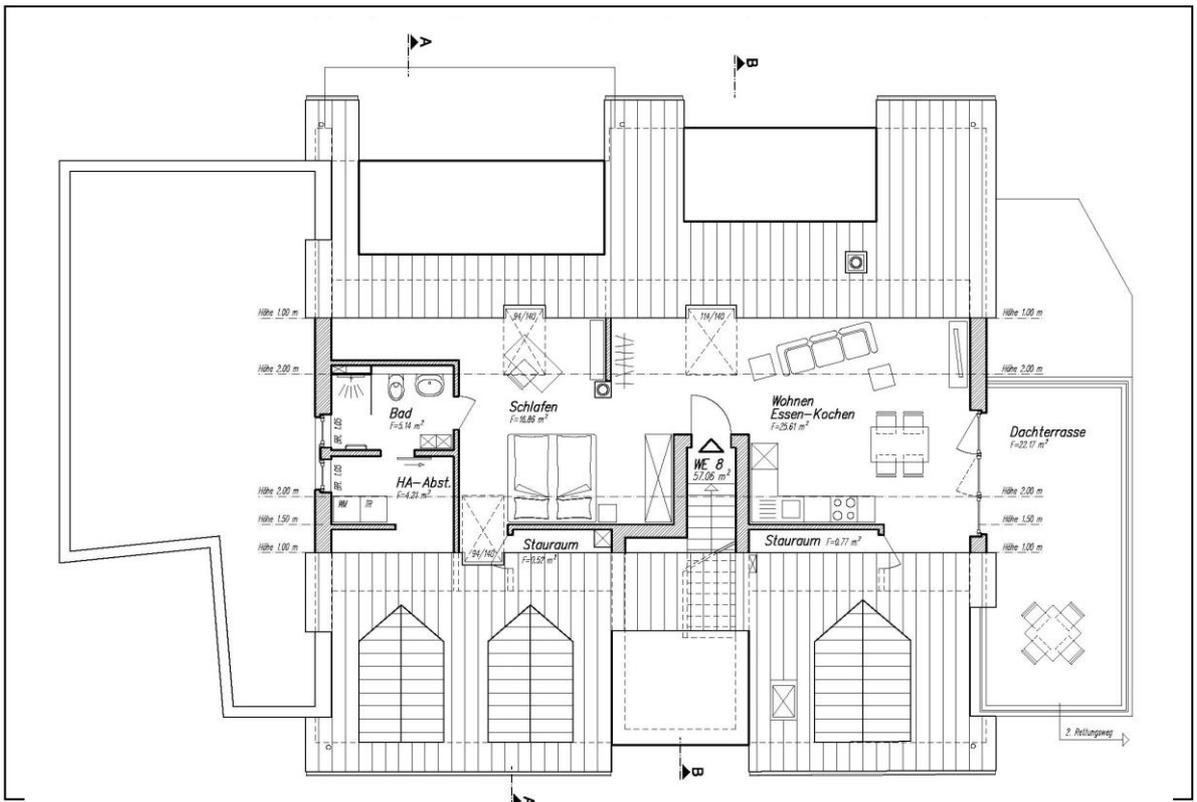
Grundriss DG 2, unmaßstäblich
